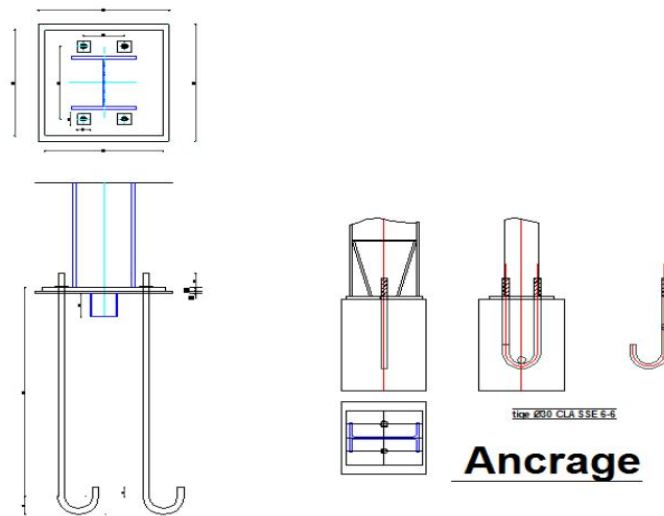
Ancrage poteau métallique à sa semelle en béton armé
